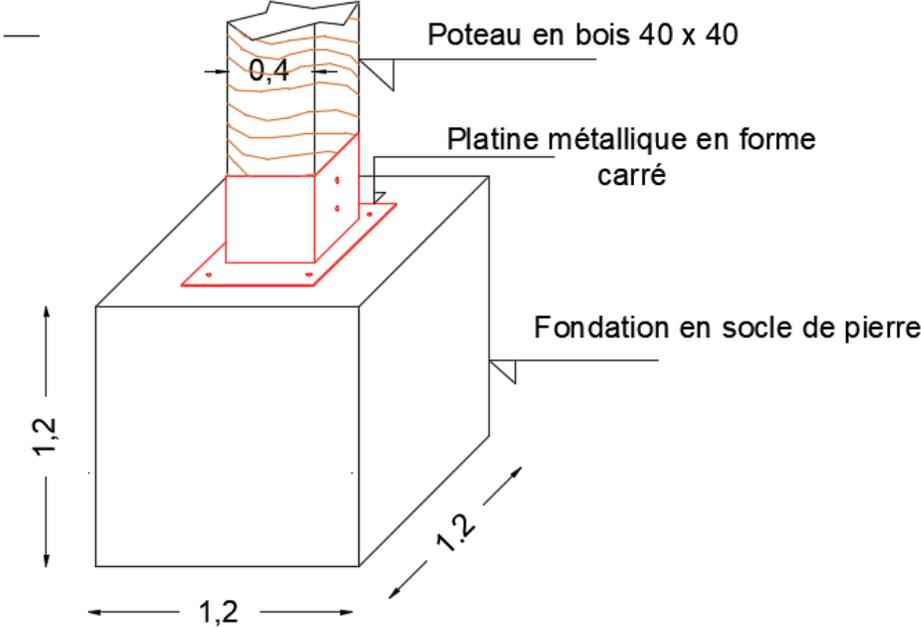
Détail fixation poteau en bois-fondation en socle de pierre. Source : Auteurs.
